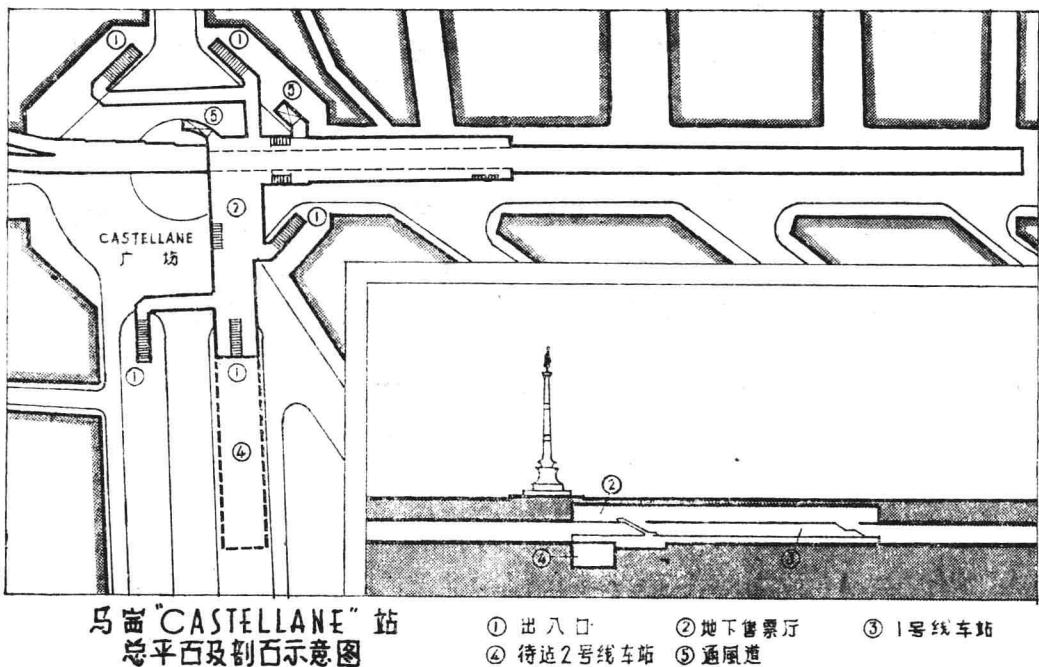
马赛“卡斯特拉恩”站总平面及剖面示意图
